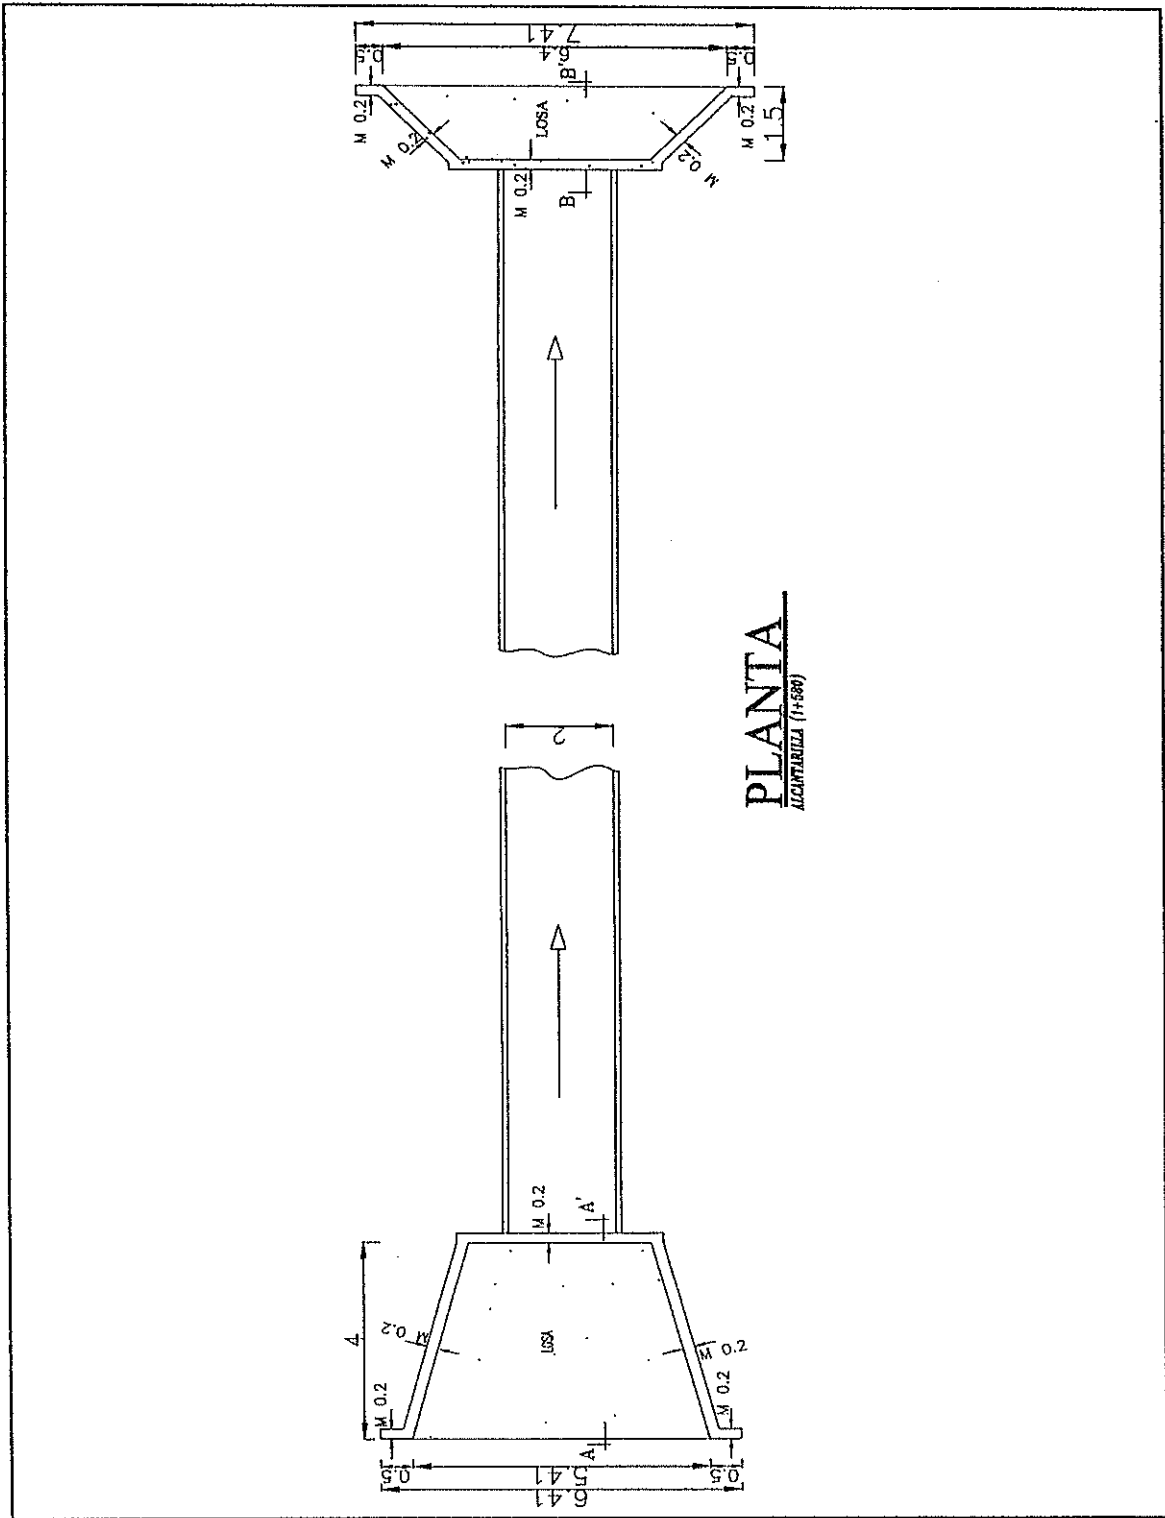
DETALLE DE ALCANTARILLA No.1
